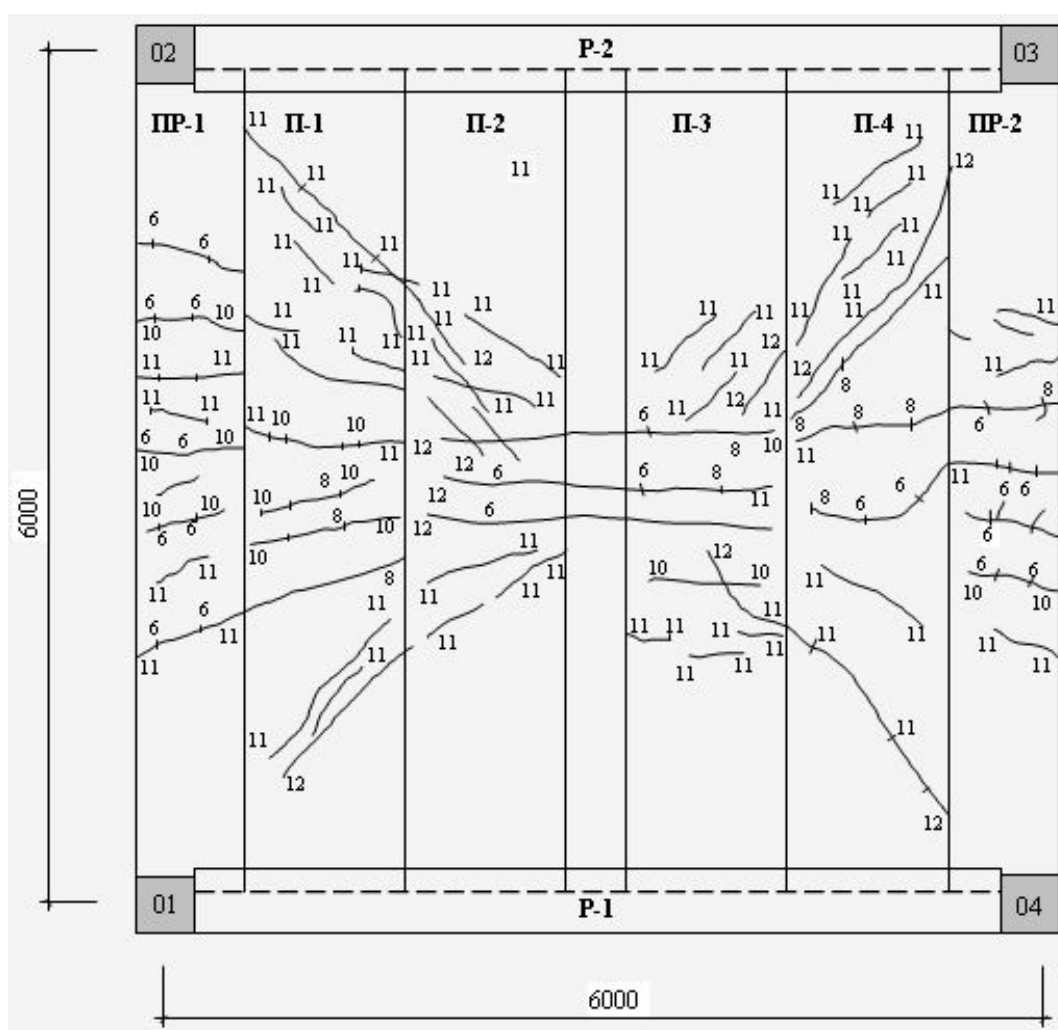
Картина распространения трещин в плитах перекрытия по низу фрагмента
